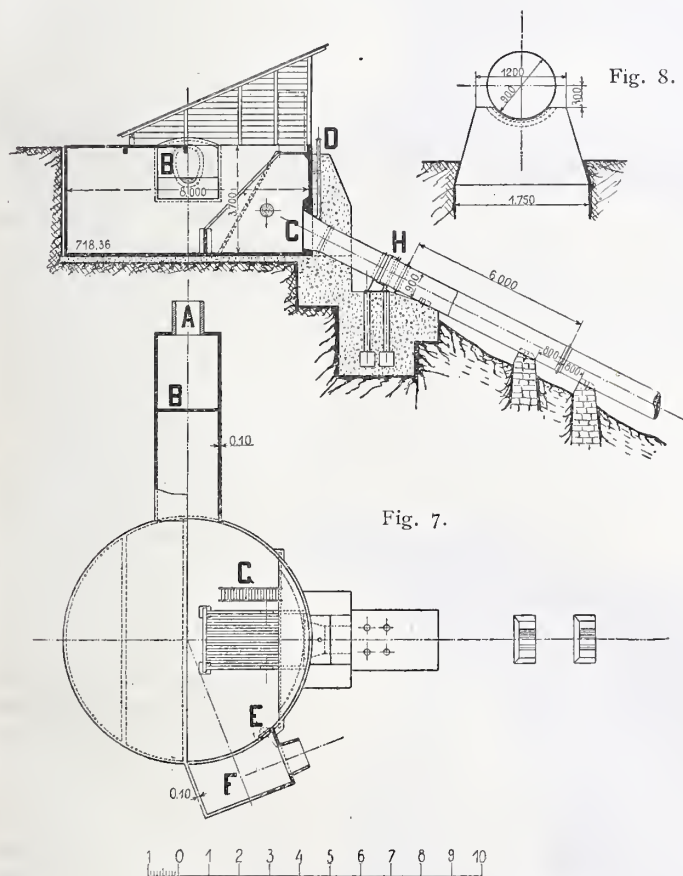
Grundriss und Schnitt des Reservoirs nebst Schnitt der Expansionsvorrichtung. 1:250.
